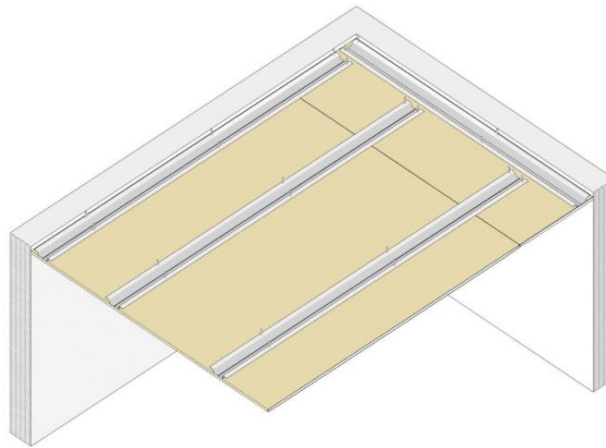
Pladur sostre 12,5 mm. Pladur Gypsum, 2021.
